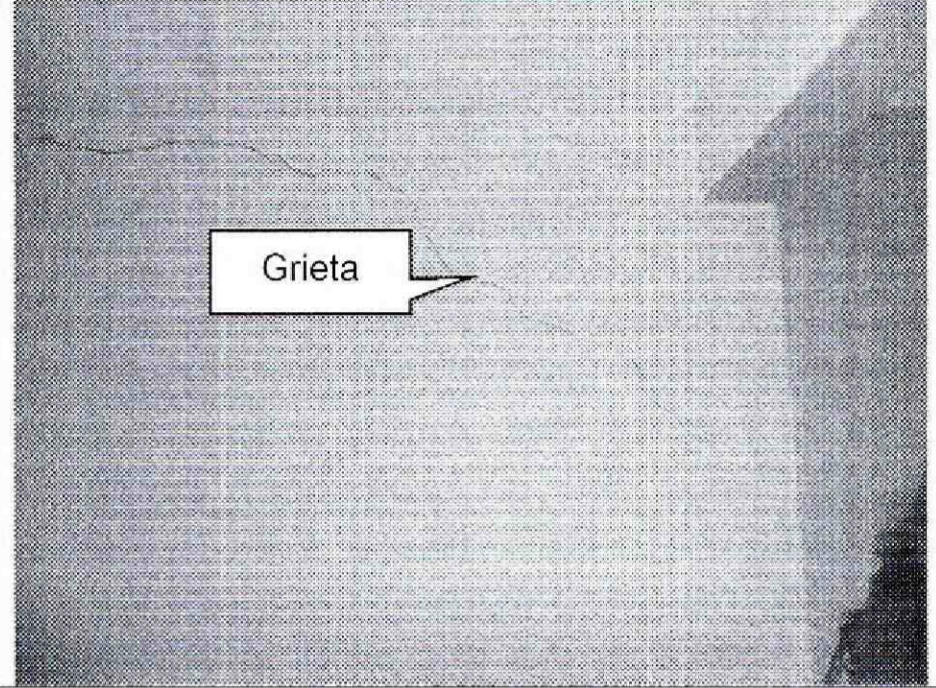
Vista de una fracción del muro de segundo (2) nivel, por encima de la zona de colapso, en el predio de la Calle 78 No. 69-48, donde se observa la presencia de grietas de tendencia irregular.
